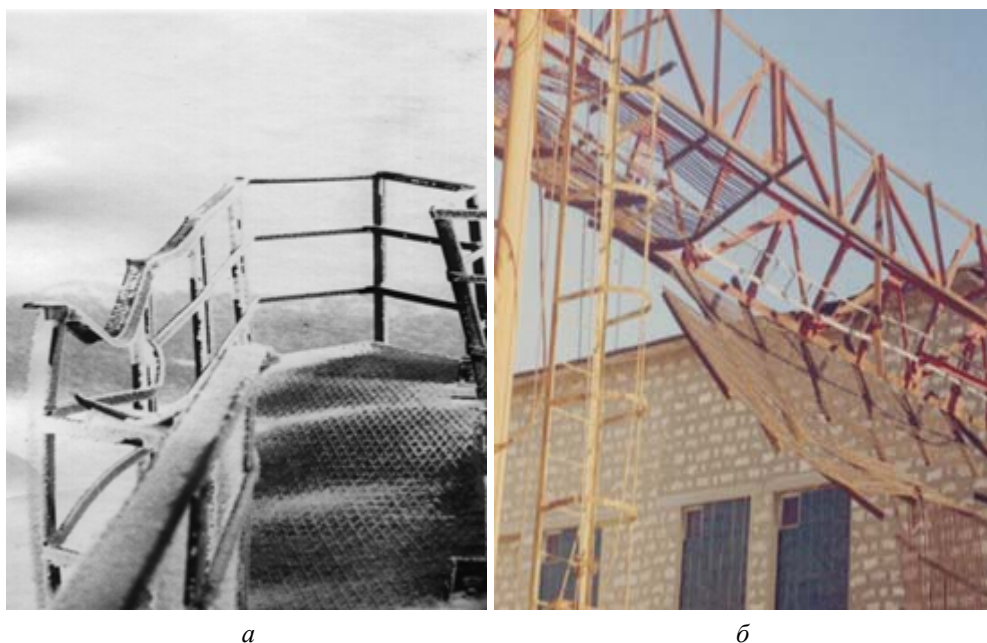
Разрушения конструктивных элементов мачты после падения «ледяной бомбы»: *а* – площадка обслуживания; *б* – волновод и железобетонное покрытие технического здания
